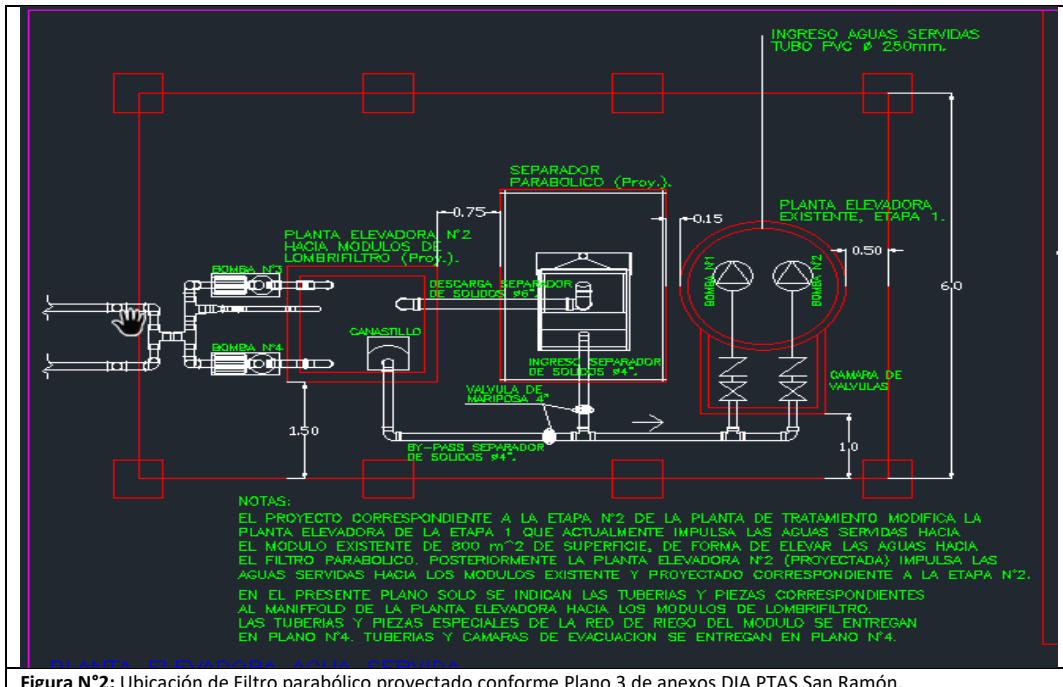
Ubicación de Filtro parabólico proyectado conforme Plano 3 de anexos DIA PTAS San Ramón,
